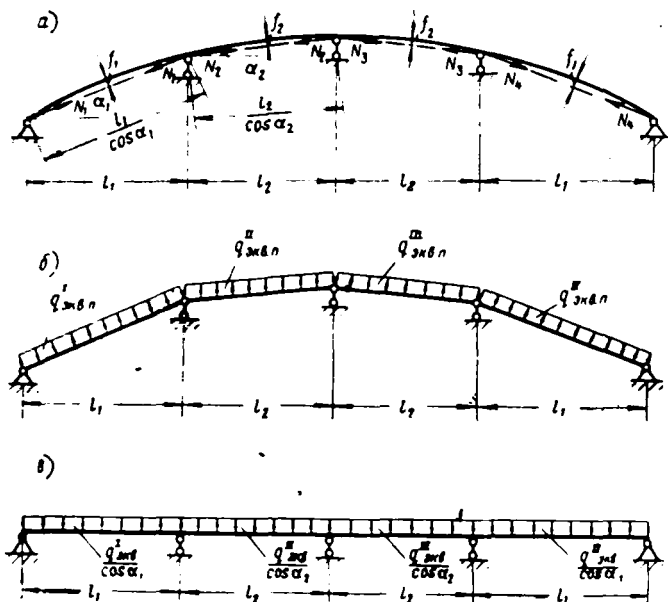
Схема расчета верхнего пояса арочной фермы
